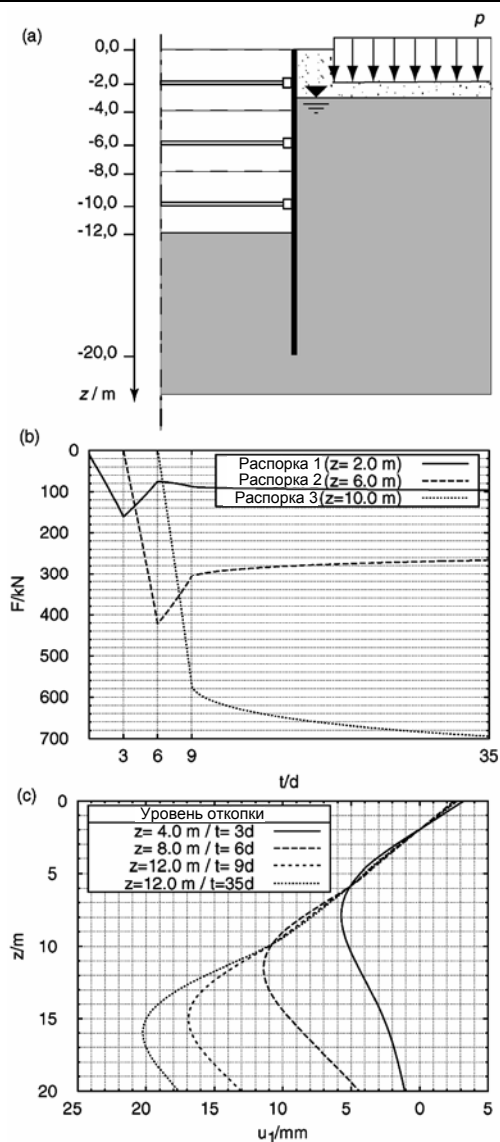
Расчетная эволюция смещений и усилий для откопки слабого грунта с раскреплением шпунтового ограждения котлована
